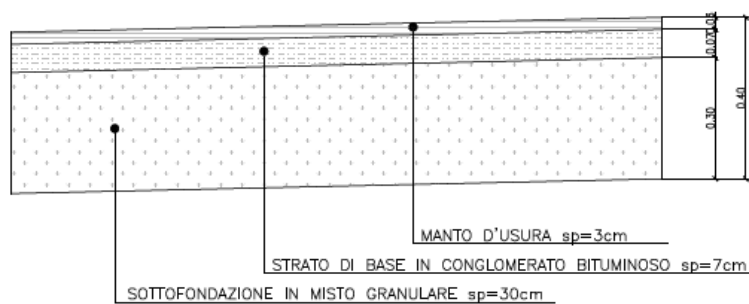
Particolare pacchetto di pavimentazione viabilità provvisoria
